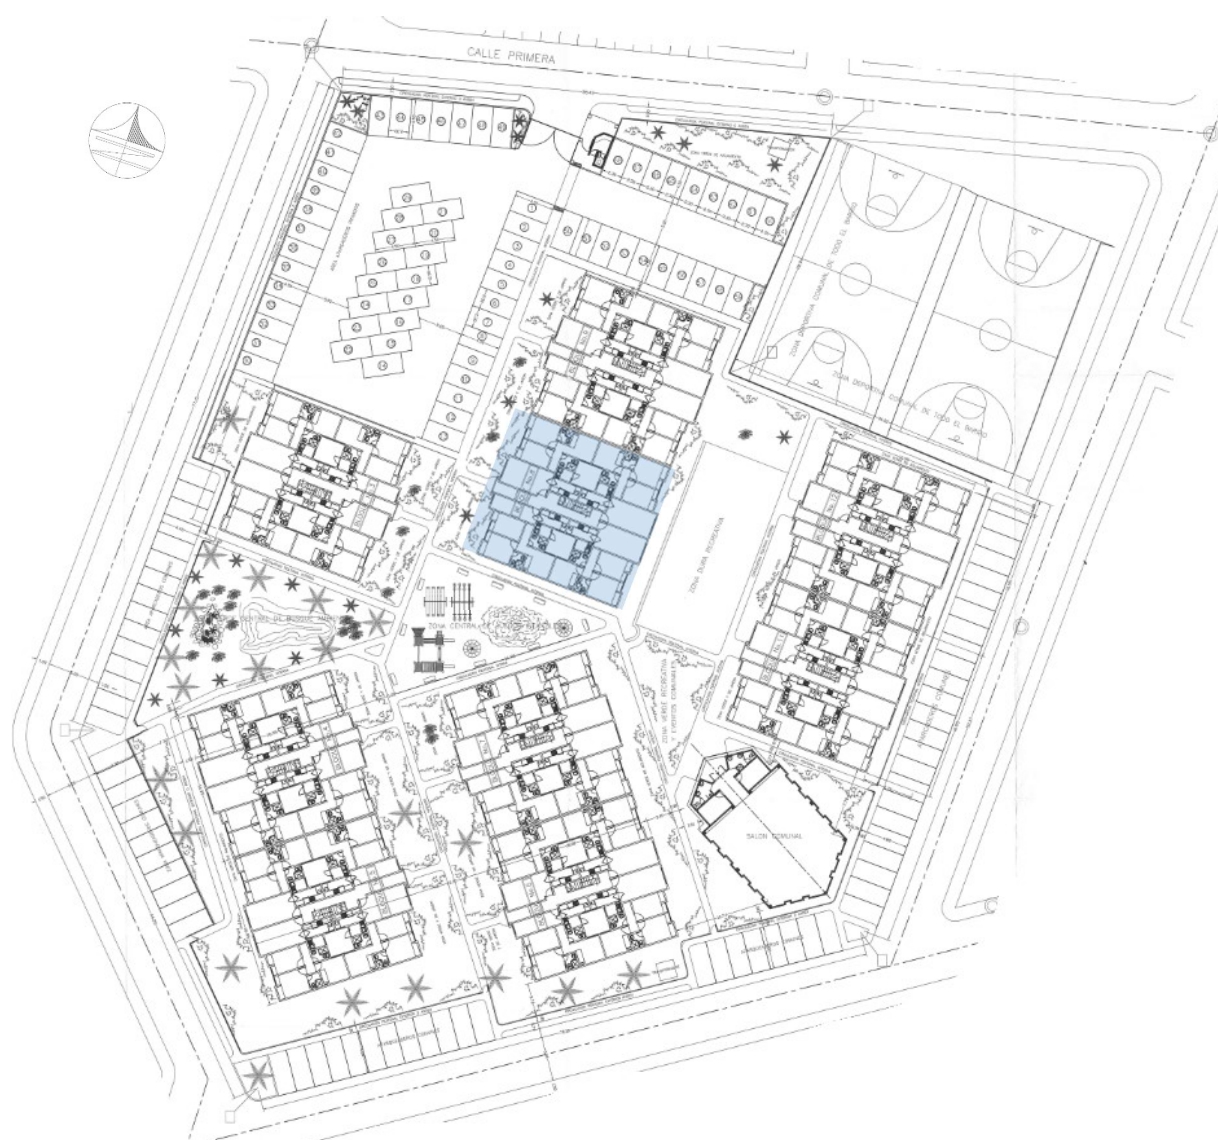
Implantación Urbanística y arquitectónica Multifamiliar Florida Parque (Fuente. Plano arquitectónico general 01).
